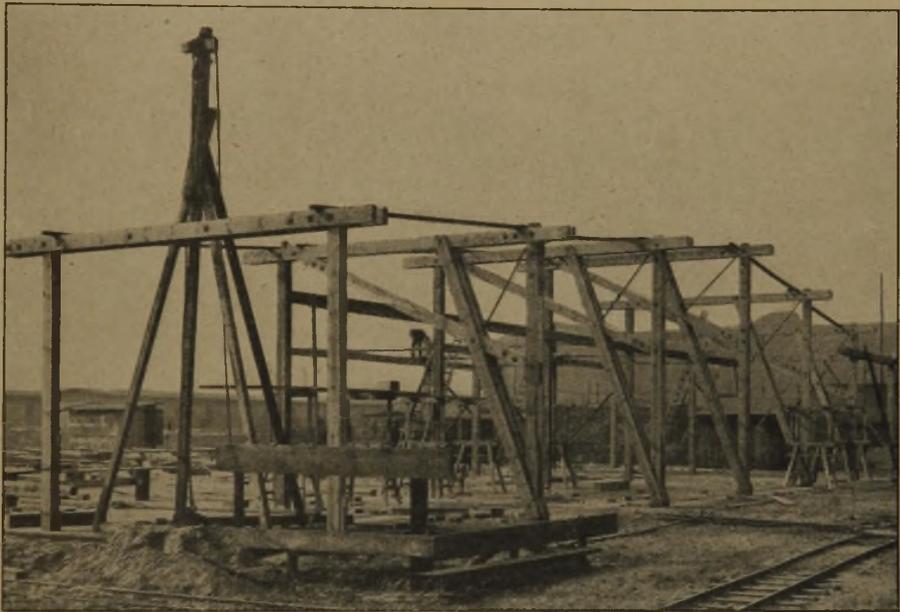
Werkstatt des Siemens-Konzerns, Berlin-Siemensstadt. Windböcke einer Giebelwand.
